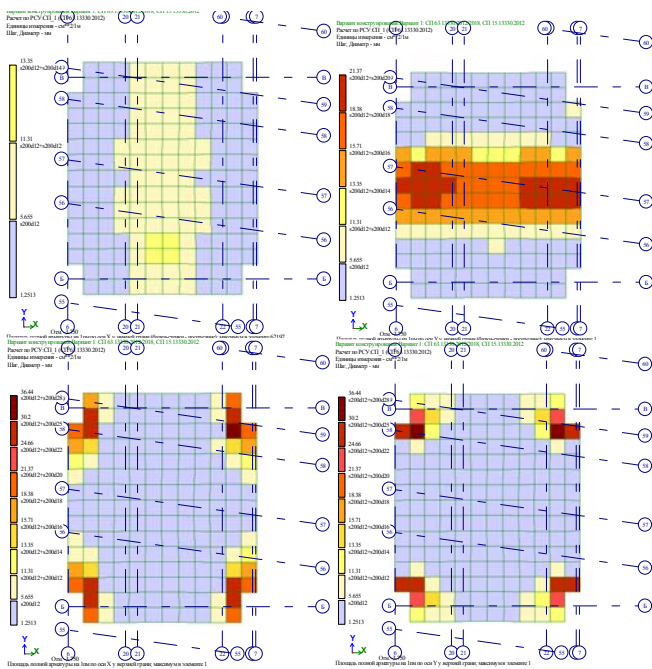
Схемы армирования покрытия автостоянки от первого варианта нагрузки (фрагмент)
